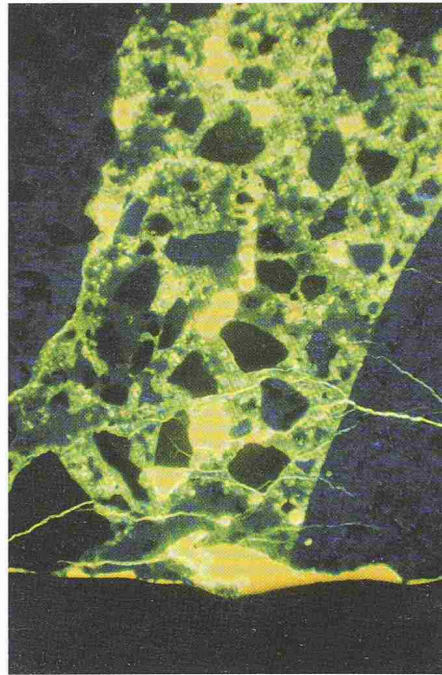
Betonoberfläche, Querschnitt: Risschäden durch Überbeanspruchung; Stocken, Schalen, Strahlen (Gefügausschnitt Vergr. 100x)
